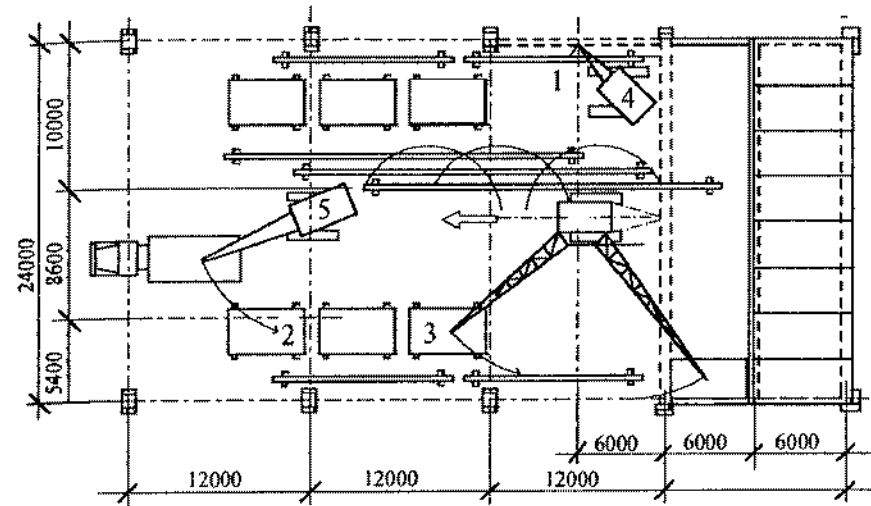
Схема раскладки и монтажа элементов покрытия одноэтажных промышленных зданий:
